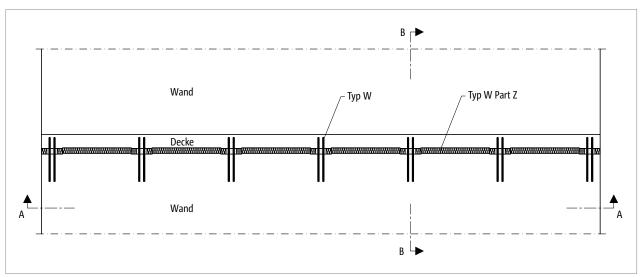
Schöck Sconnex® Typ W: Anschluss zwischen Wand und darüberliegender Decke – Einbau am Wandkopf
